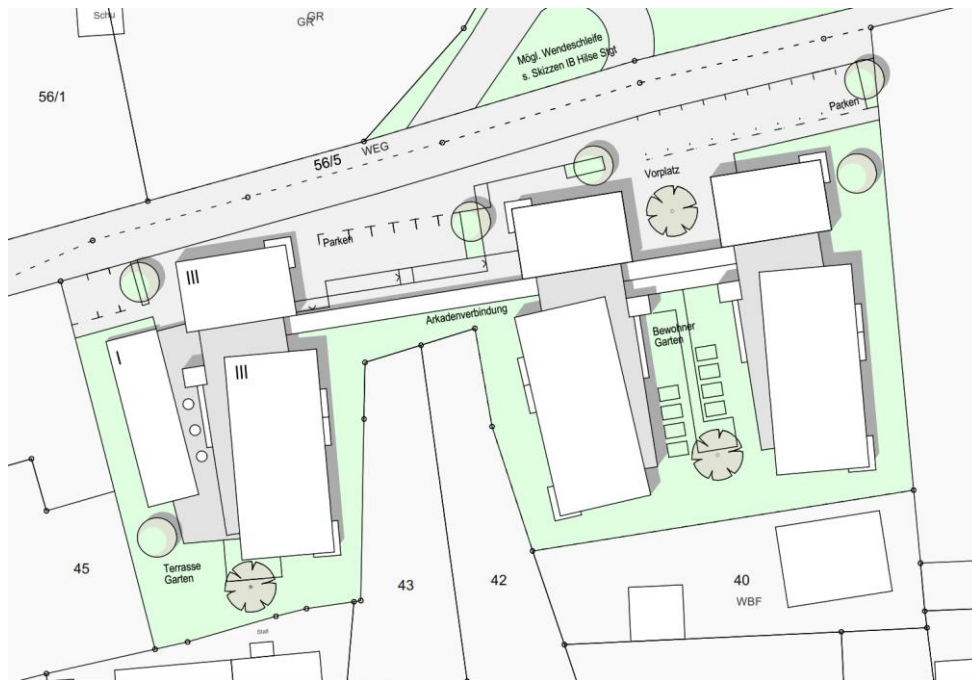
Mögliche Umsetzung des Bebauungsplans. Quelle: Ausschnitt Lageplan Büro Koziol/Thümmel, Stand 07/2022
